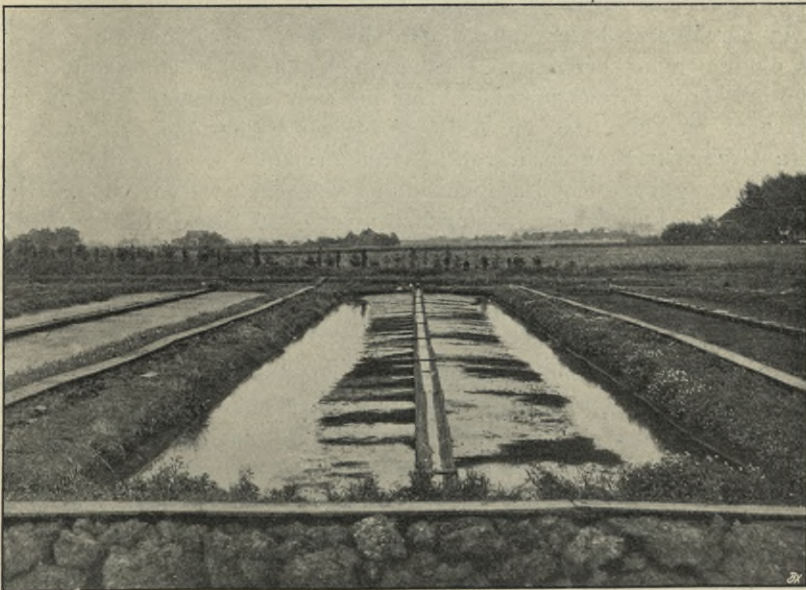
Tropfkörper mit Deckschicht nach Dunbar (während der Beschickung) in Unna.
